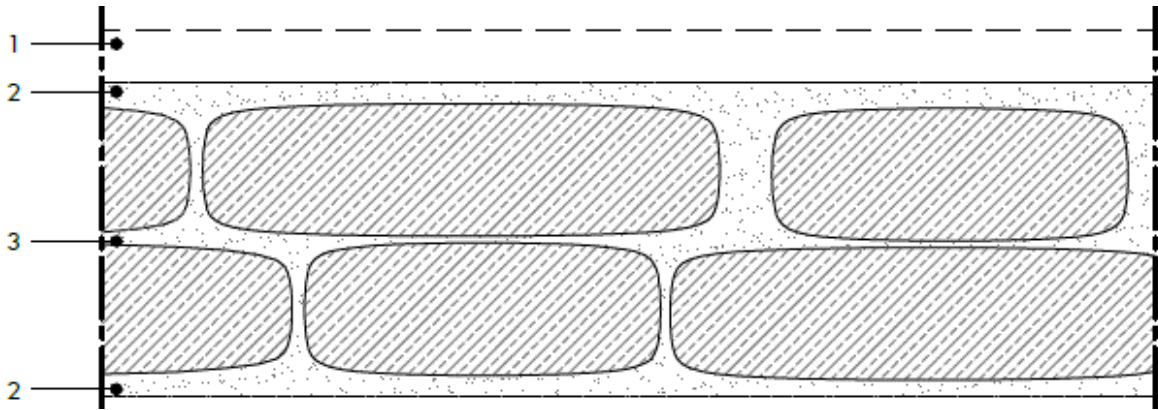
Pormenor construtivo das paredes exteriores laterais e de fachada
